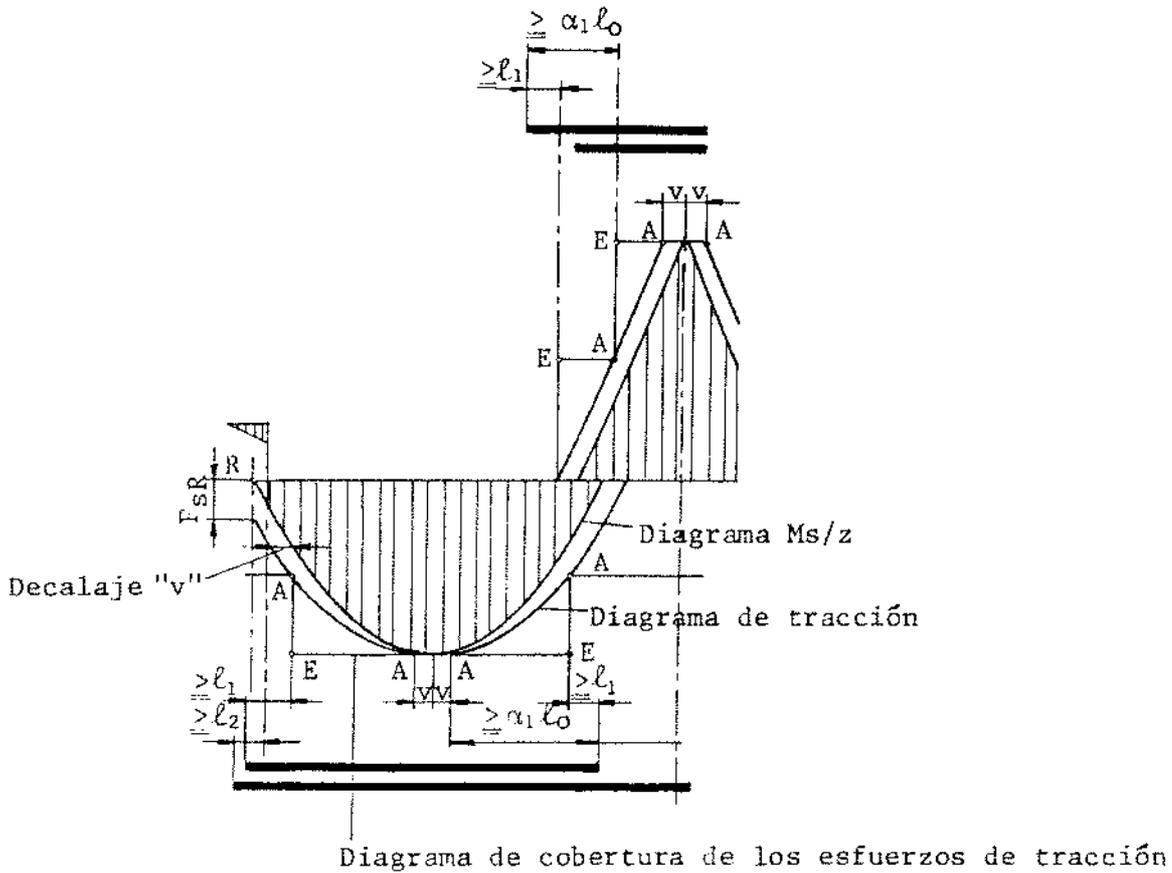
Ejemplo de una armadura escalonada en losas armadas con barras de $d_s < 16$ mm.
